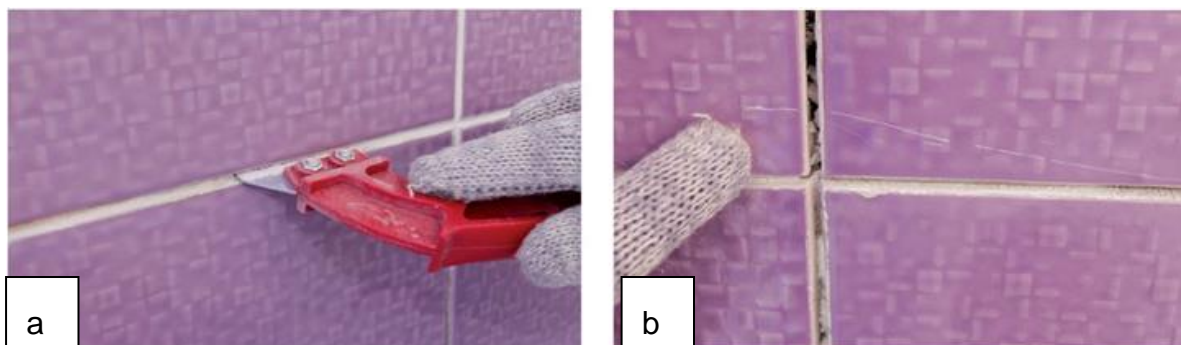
Rejuntas com sujeira ou com fissuras e quebras (foto a) e raspagem de rejunte utilizando raspador com lâmina de tungstênio (foto b)
